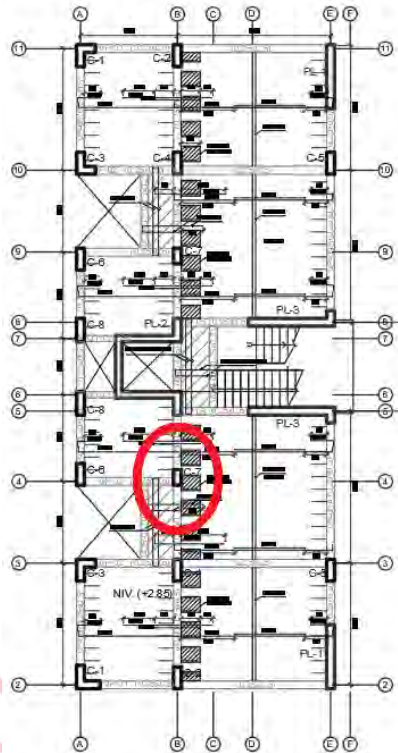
Ubicación de zapata a diseñar en plano de encofrado
